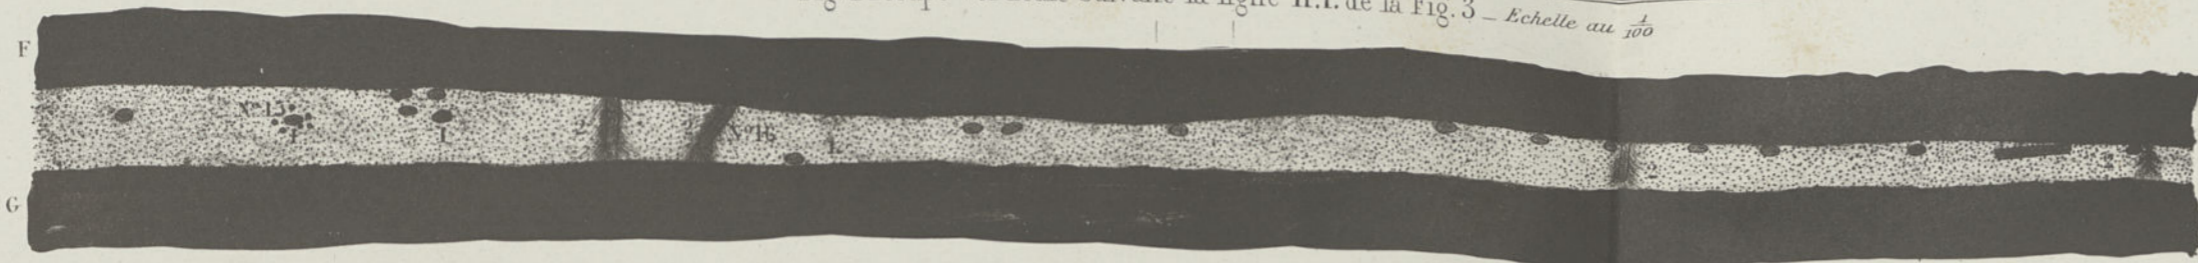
Coupe verticale suivant la ligne J.K. de la Fig. 3 - Echelle au 1/100
